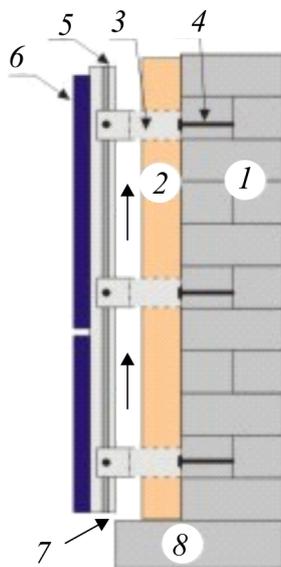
Схема вентилируемого фасада: 1 – стена;
